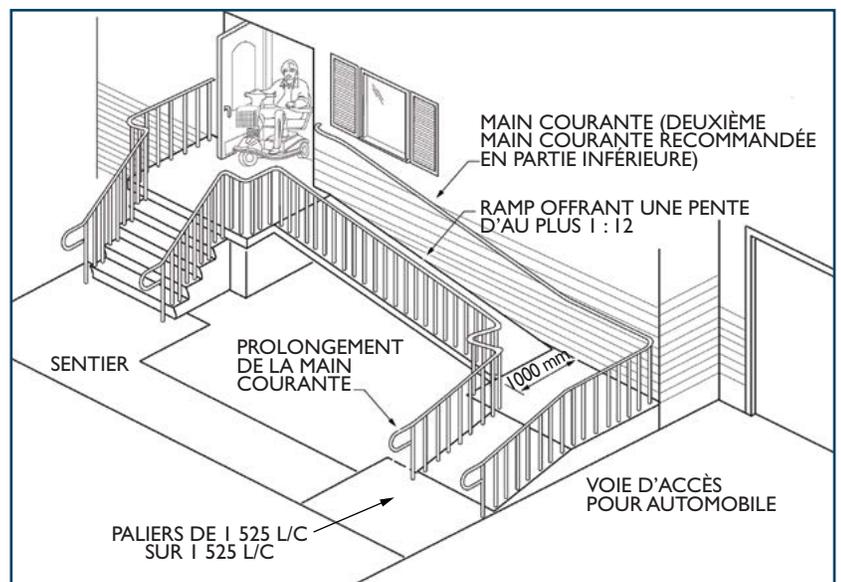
Rampe d'accès en béton construite sur les lieux (en forme de L)
